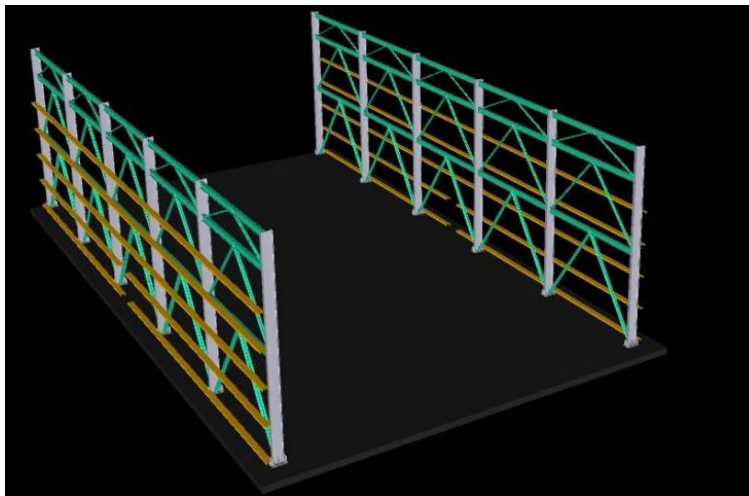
Montaje de columnas y arriostramiento en ejes 1 - 4
